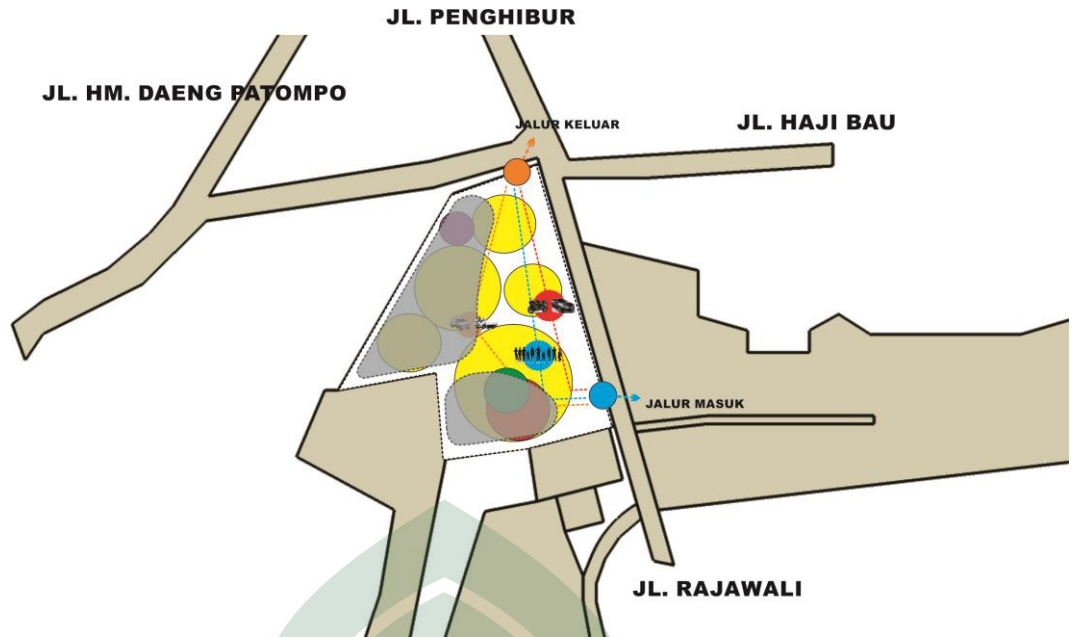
Penggabungan Pendekatan Zoning dan Pendekatan Sirkulasi Alternatif 1
